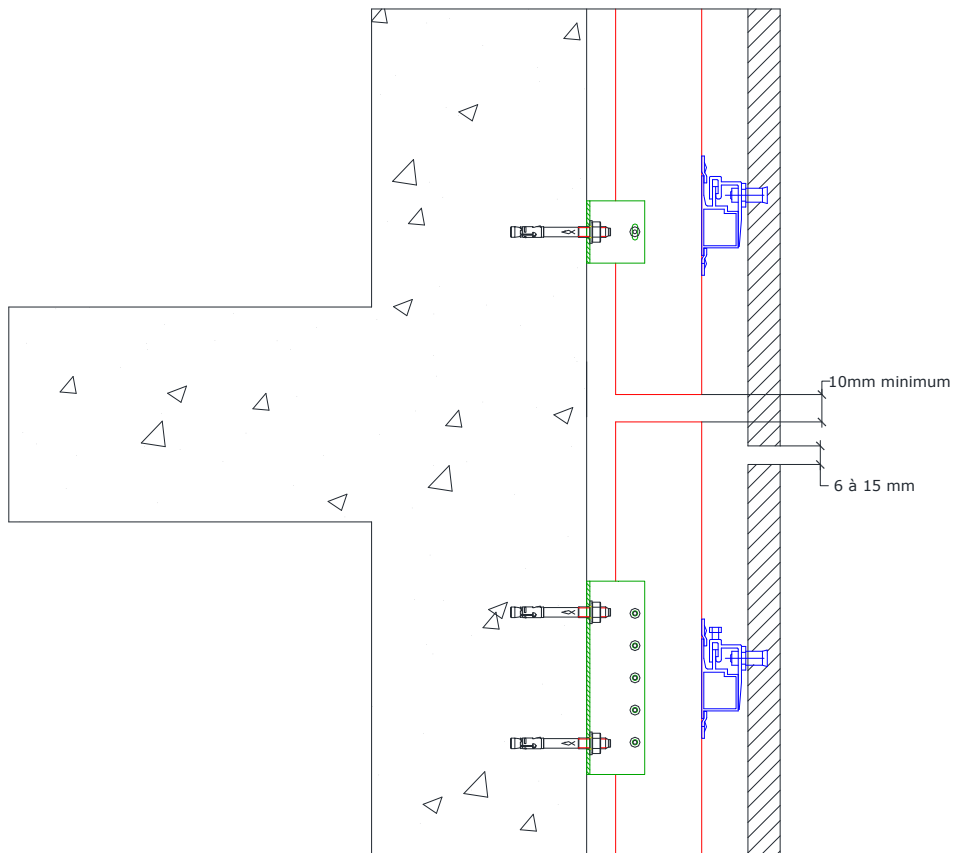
Fractionnement au droit de chaque plancher sur COB
